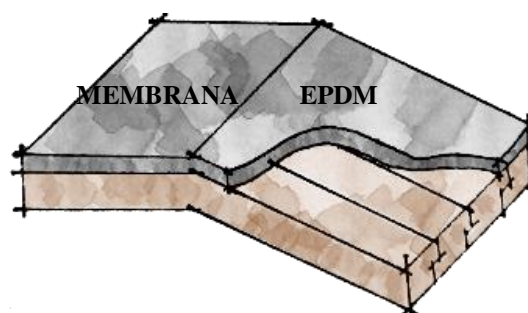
Cubierta de madera laminada. Fuente: elaboración propia.
